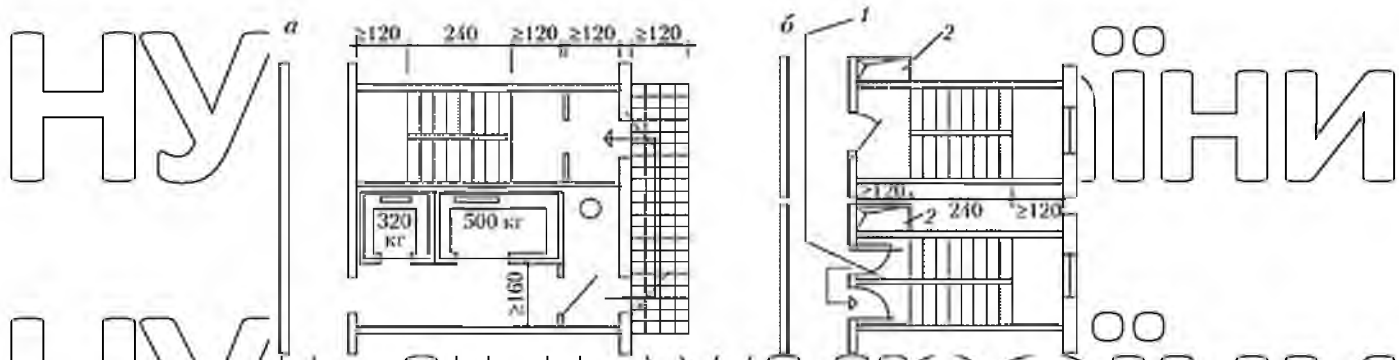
Захист сходів від задимлення: *а* - незадимлювана сходи з переходом через зовнішню відкриту зону; *б* - закрита сходи з системою підпору повітря; *1* - неспаленна перегородка; *2* - шахти для підпору повітря
